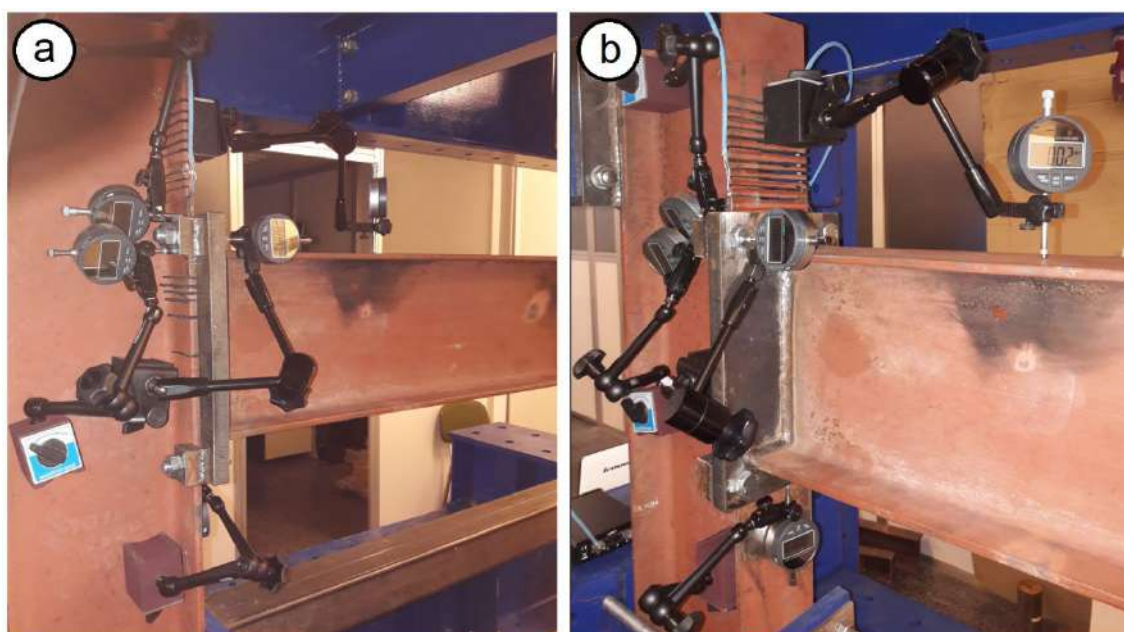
a) Vista posterior del anclaje de la placa de cabeza de la viga (viga en voladizo) unida mediante grapas al pilar. b) Vista frontal del anclaje de la placa de cabeza de la viga unida mediante grapas al pilar (Cabaleiro et al. 2020).
